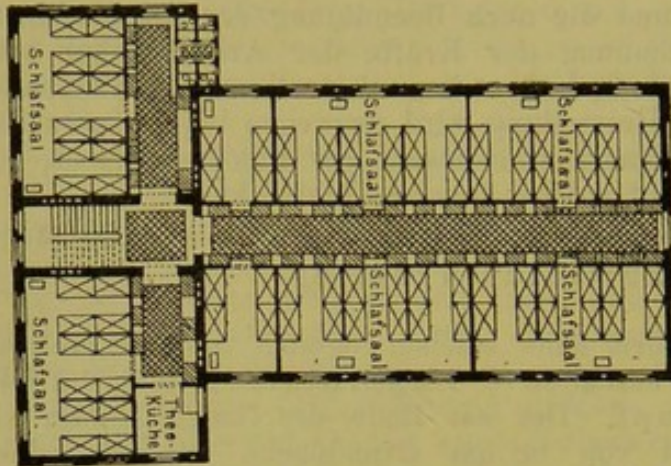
Heimstätte für Fabrikarbeiterinnen in Stuttgart. Grundriß des Hauptgeschosses.
